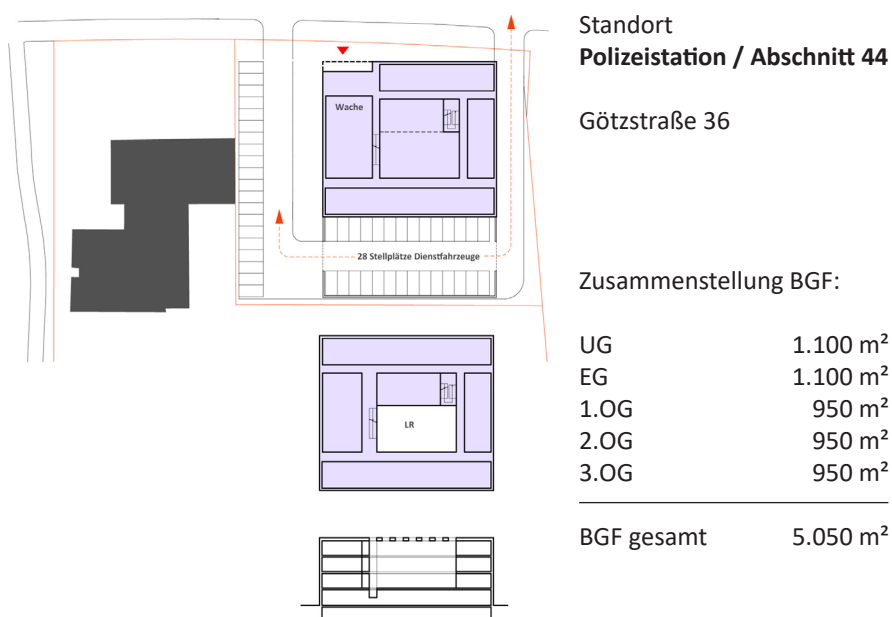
Machbarkeitsstudie: Neubau Götzstraße 36 / Grundrisschema mit Flächenberechnung
